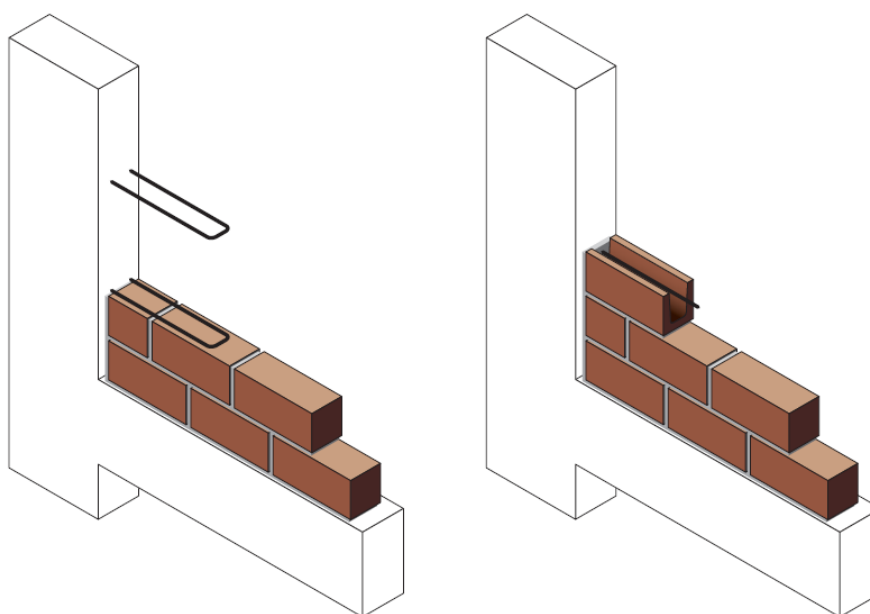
Ligações entre alvenarias e pilares com gancho de aço de dois ramos ou com auxílio de blocos tipo canaleta. Fonte: Thomaz et al. (2009).
